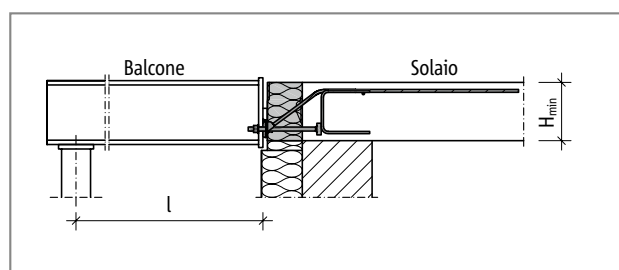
Schöck Isokorb® XT tipo SQP: schema statico
